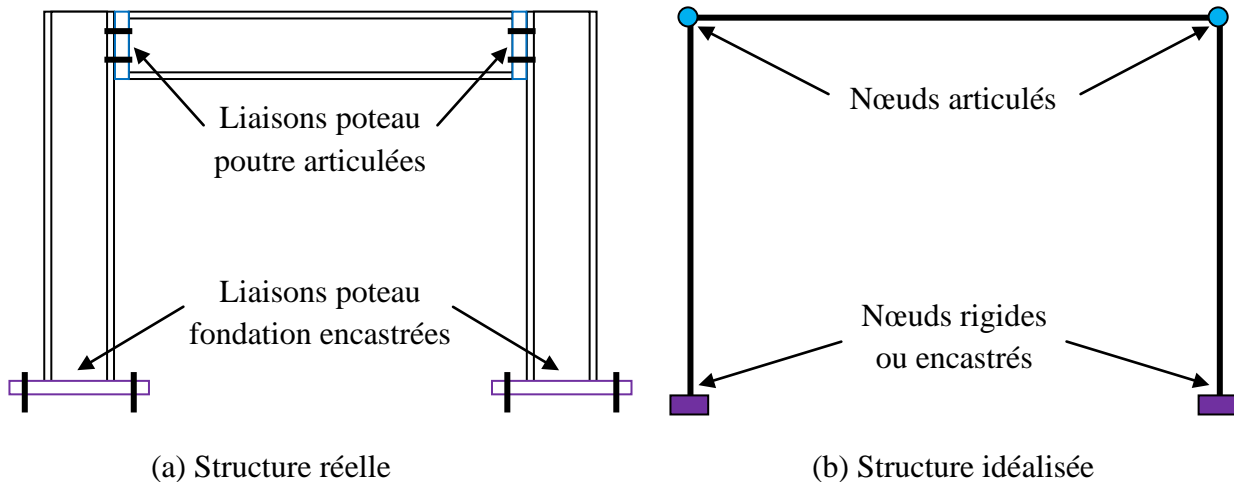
Différentes liaisons dans un portique métallique : poteau poutre et poteau fondation.
